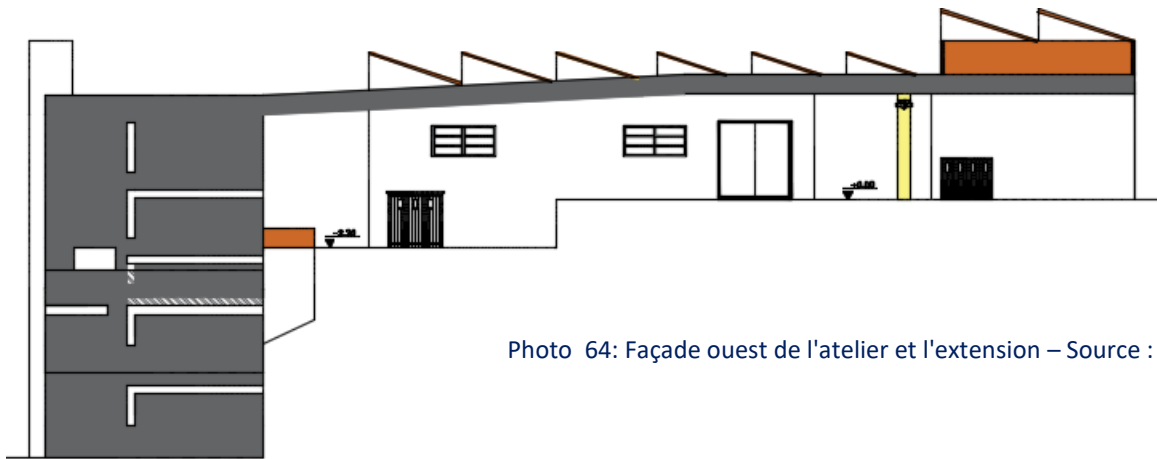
Façade ouest de l'atelier et l'extension – Source : Auteur
